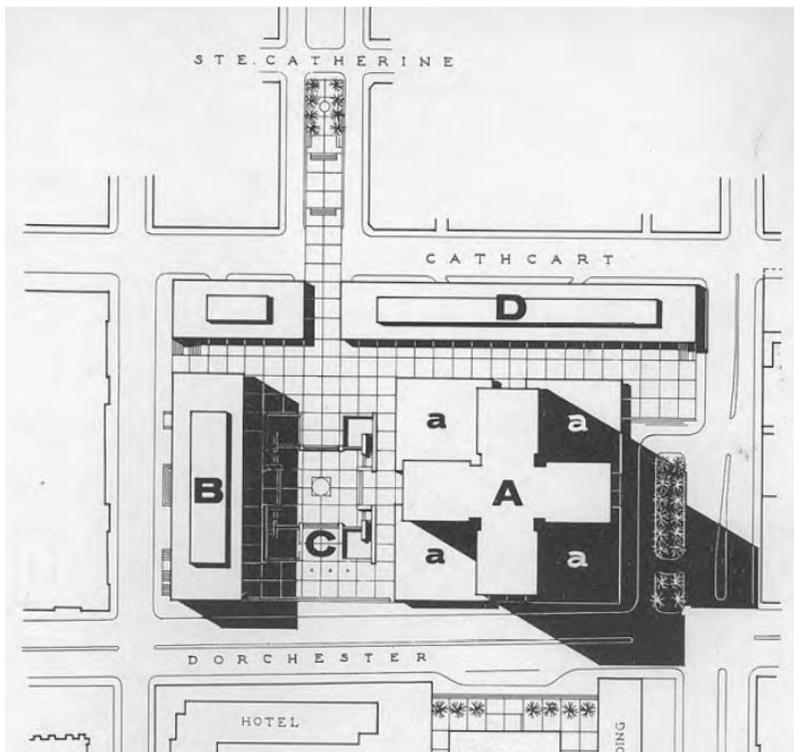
Plan initial de la passerelle piétonne devant passer au-dessus de la rue Cathcart et lier l'esplanade Ville-Marie à l'avenue McGill College. Plan 1959.
